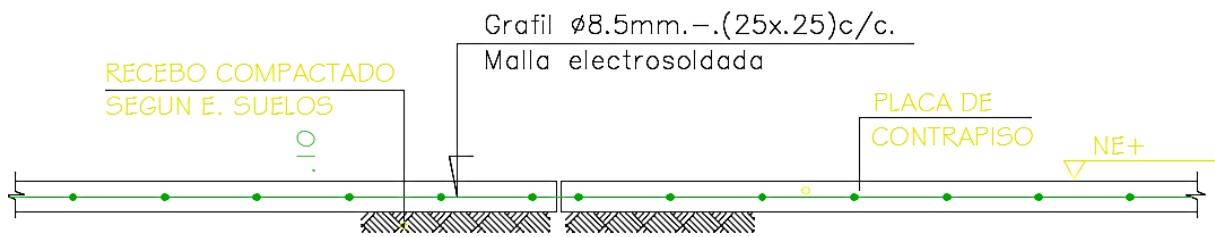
Corte típico de placa de contra piso Zona A, Mezzanine. Fuente:
